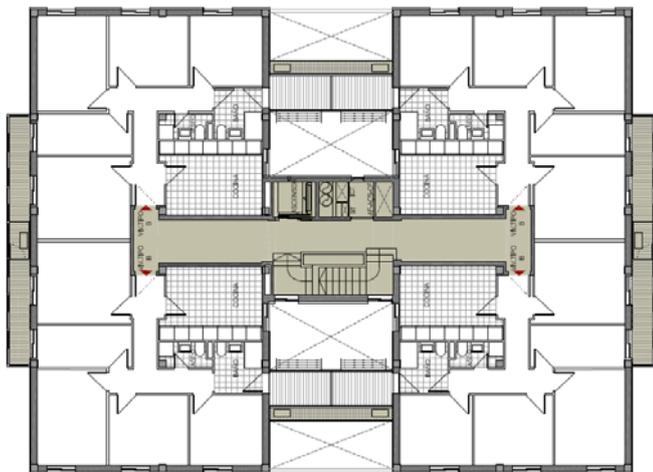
Planta y alzados tipo bloque plurifamiliar densidad alta
